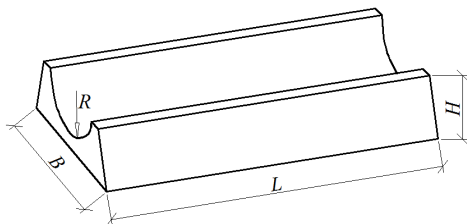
Лекальный блок для железобетонной безнапорной раструбной трубы
